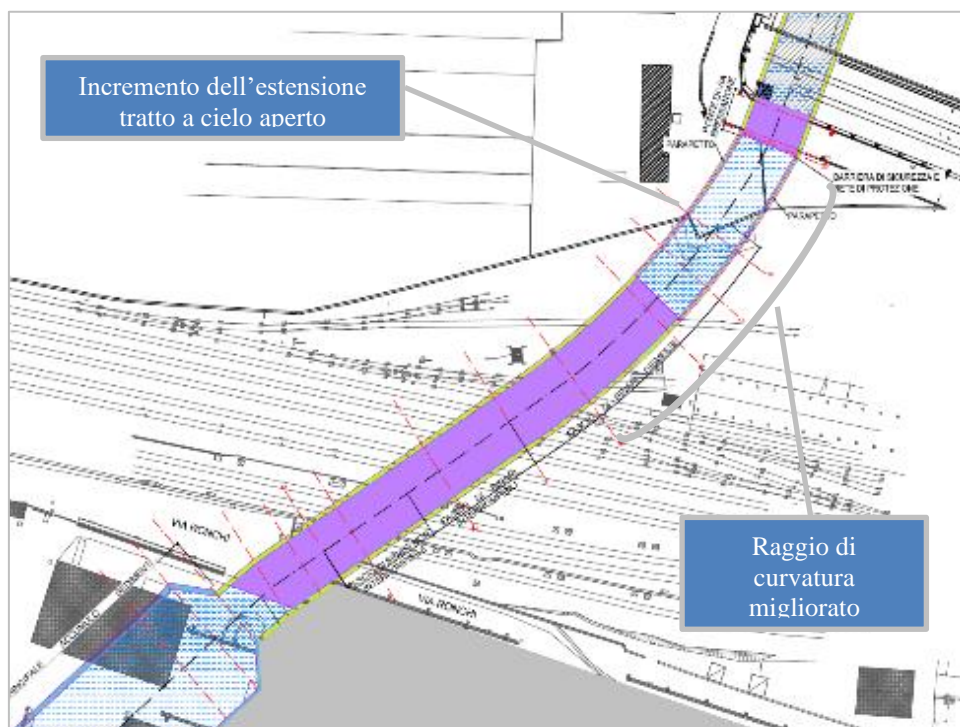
Planimetria progetto definitivo in corrispondenza dell'attraversamento del parco ferroviario
